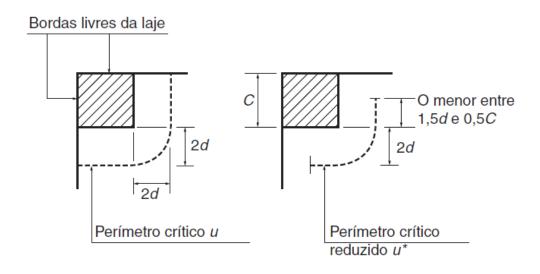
Perímetro crítico em pilares de canto Fonte: NBR 6118:2014
